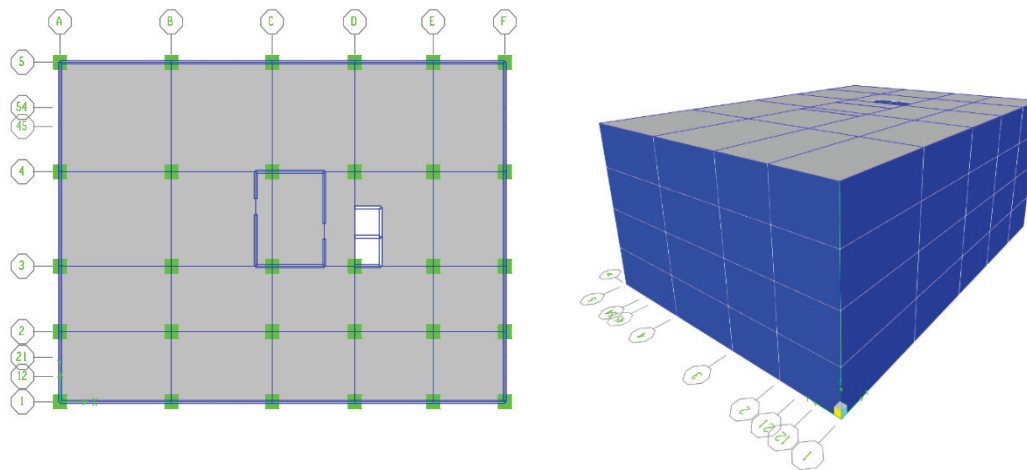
Vu en plan et 3D de l'infrastructure.
